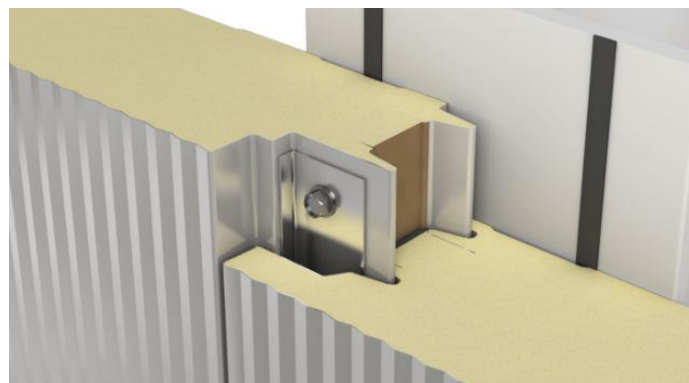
Sandwich Wandpaneel mit PU Dämmung
